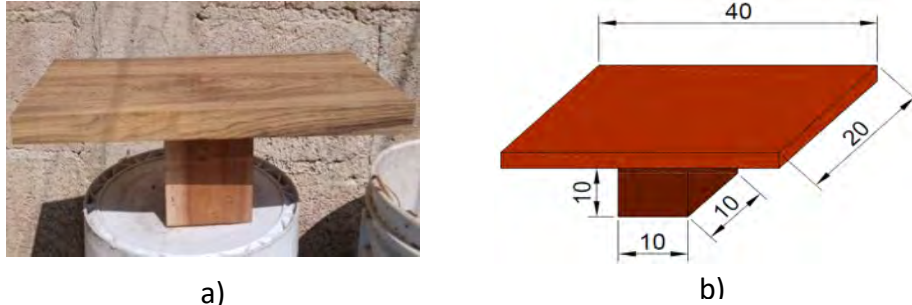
Sistema de piso a base de vigueta pretensada y módulo recuperable de madera.
